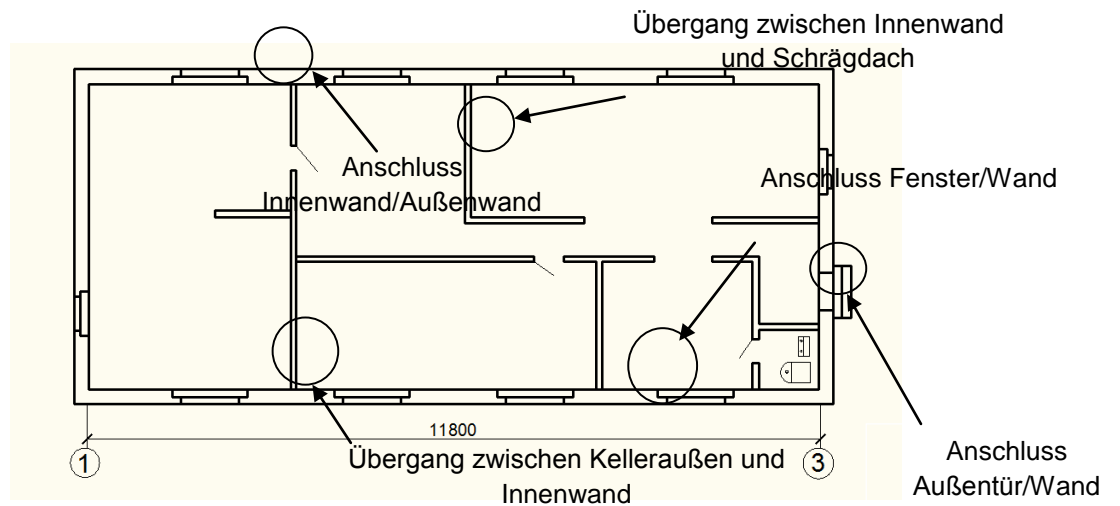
Das Fünfzigjahre–Siedlungshaus: Grundriss Erdgeschoss
